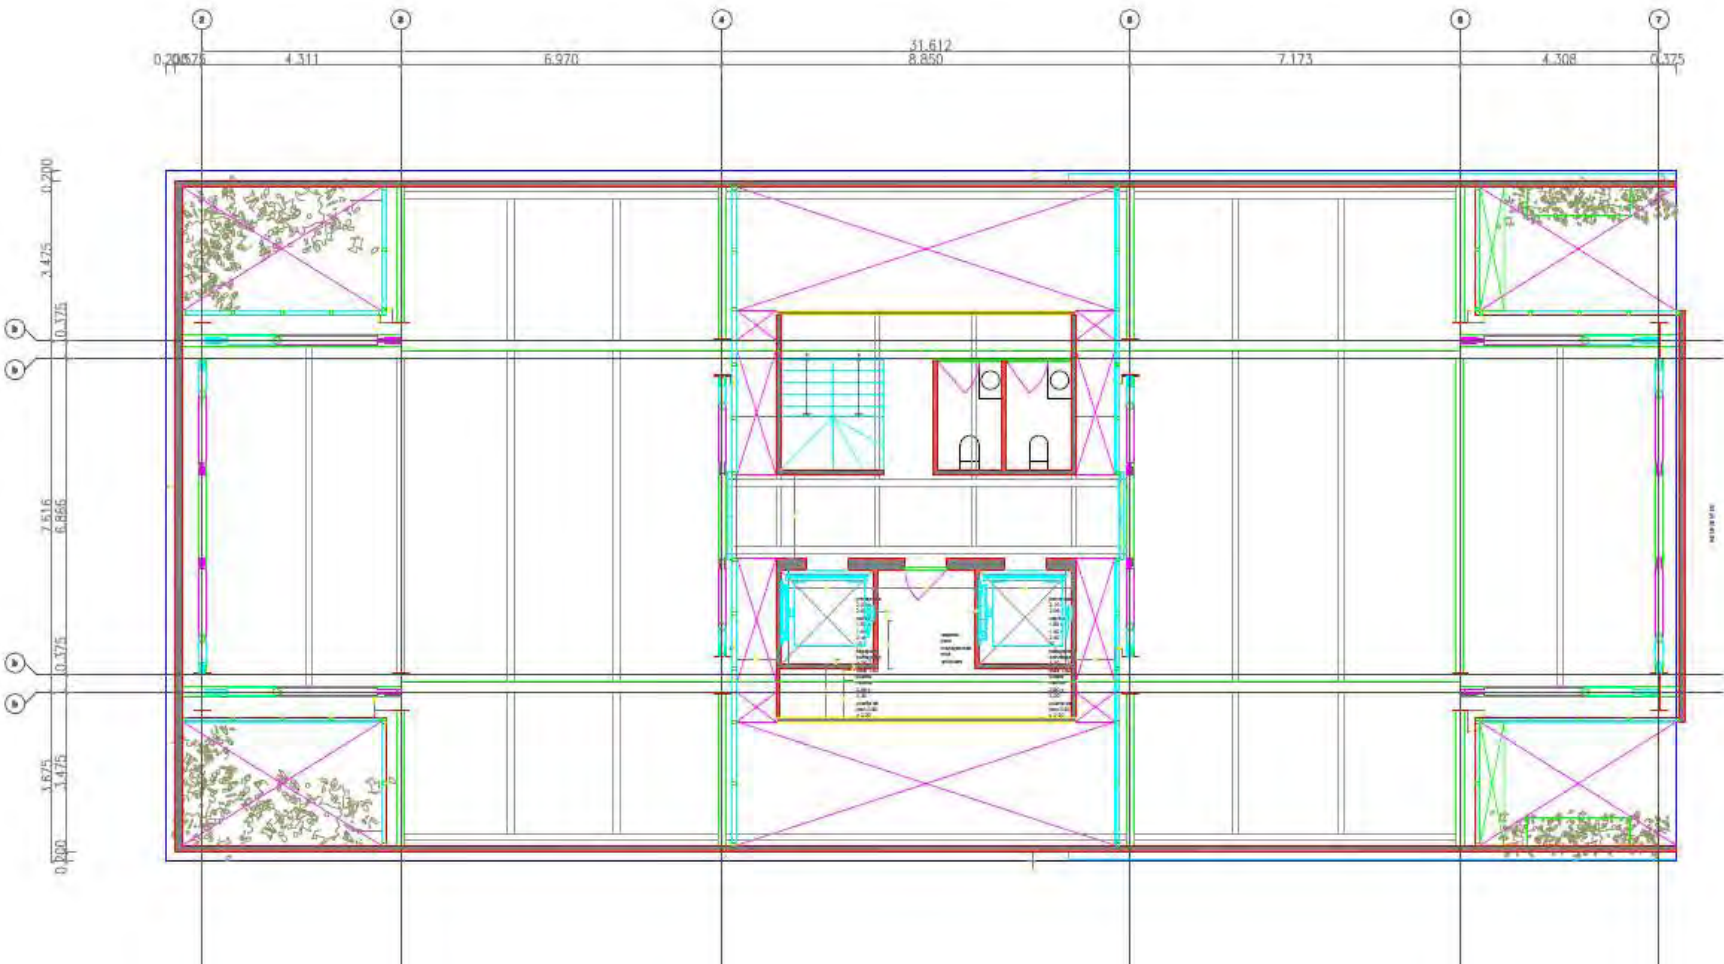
PLANTA TIPO TERCER A QUINTO NIVEL (OFICINAS)
